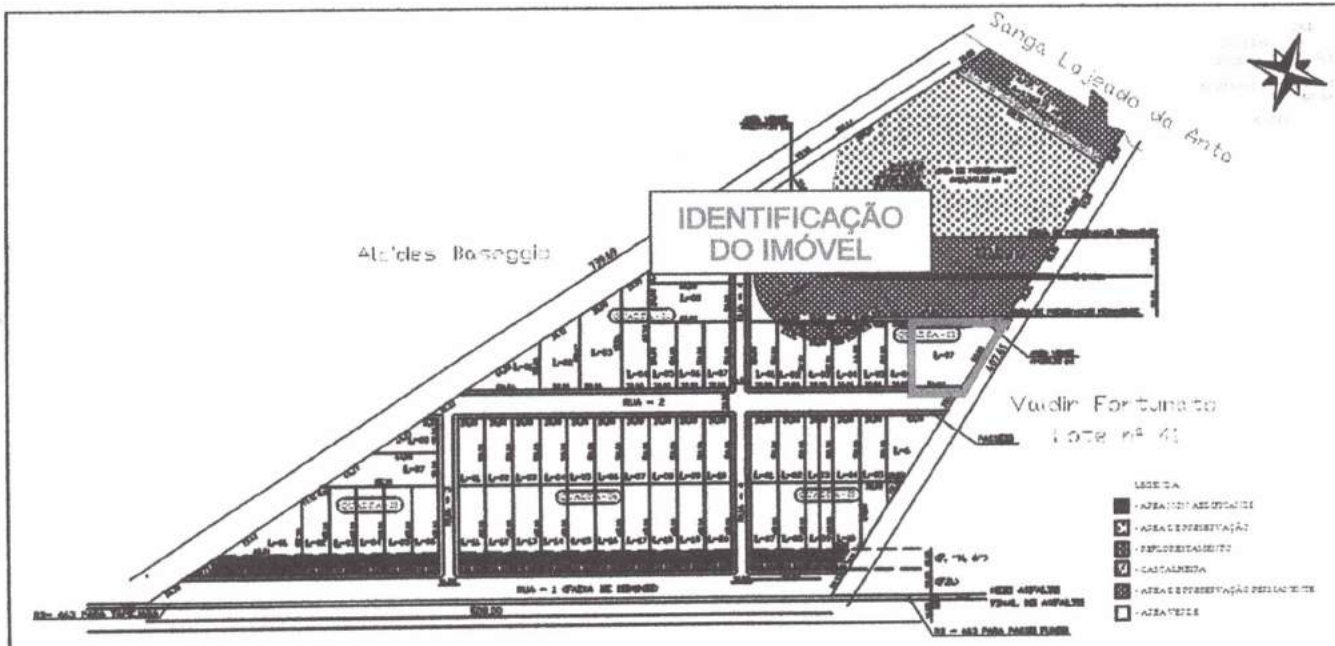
Planta do loteamento, em vermelho o terreno do imóvel em questão.
